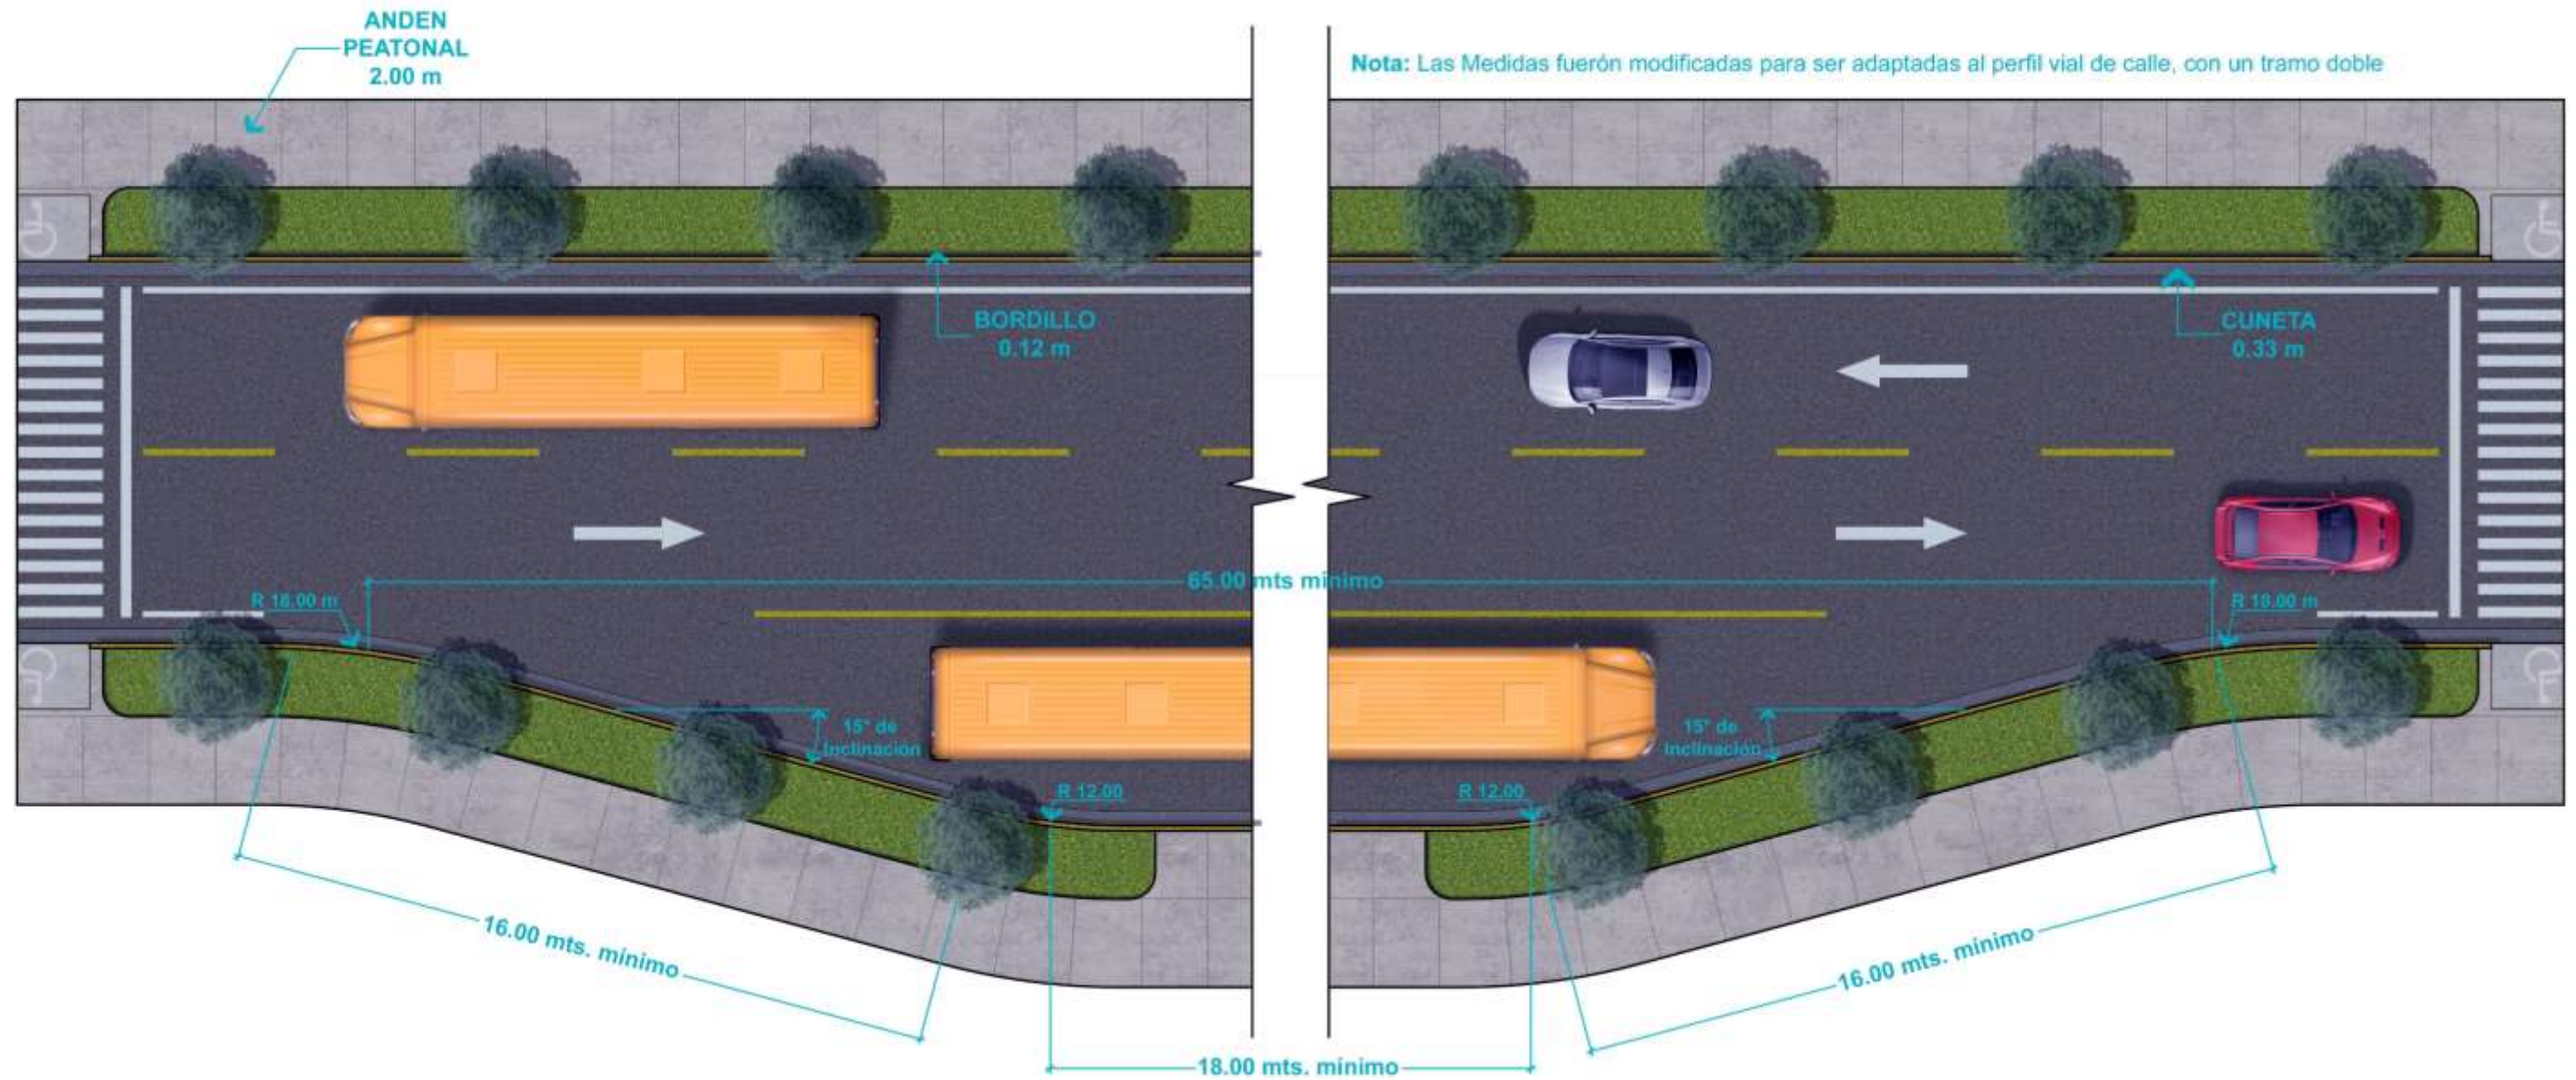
Planta de Bahía de Buses del Transporte Urbano Colectivo - ALMA. (Autoría Propia, Febrero 2023)
